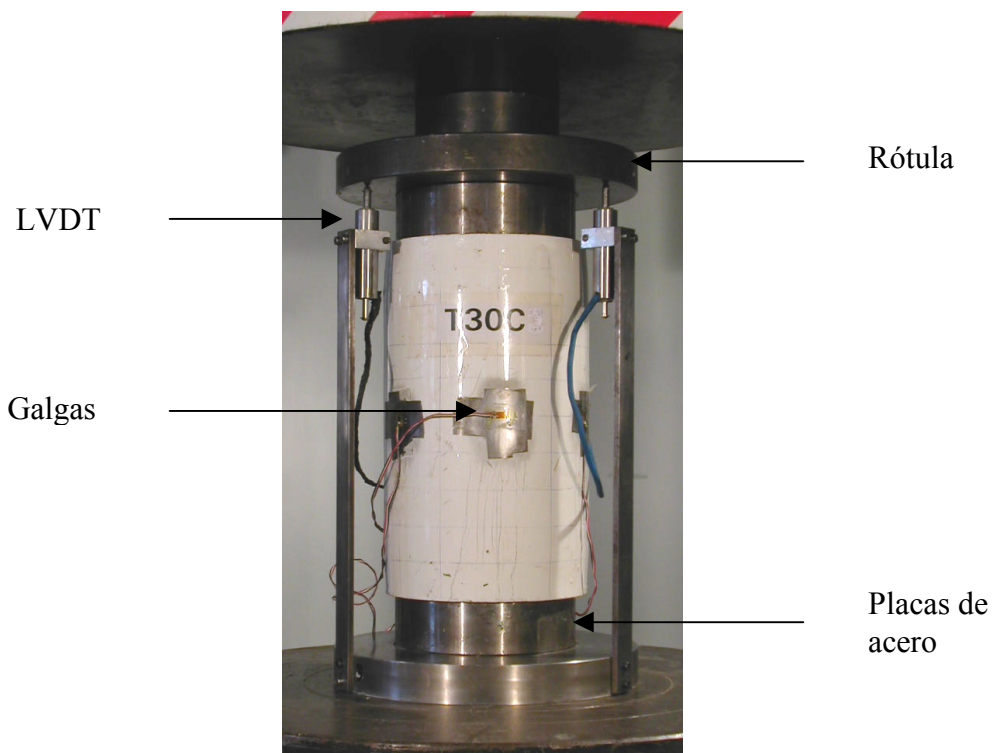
Instrumentación de probetas para ensayo de hormigón confinado con tubo de acero
